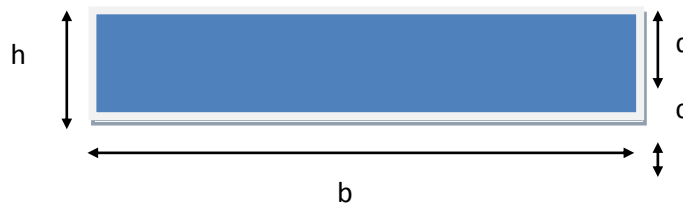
Pré- dimensionnement de L'acrotère.
